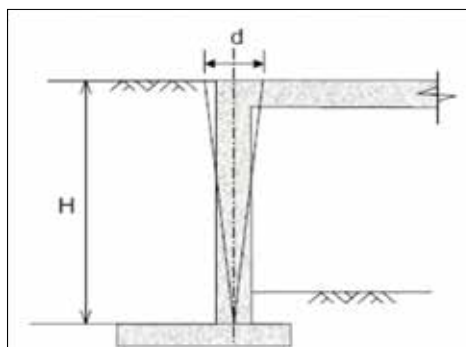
Distribusi Tekanan tanah sistem Full Height Abutment.
